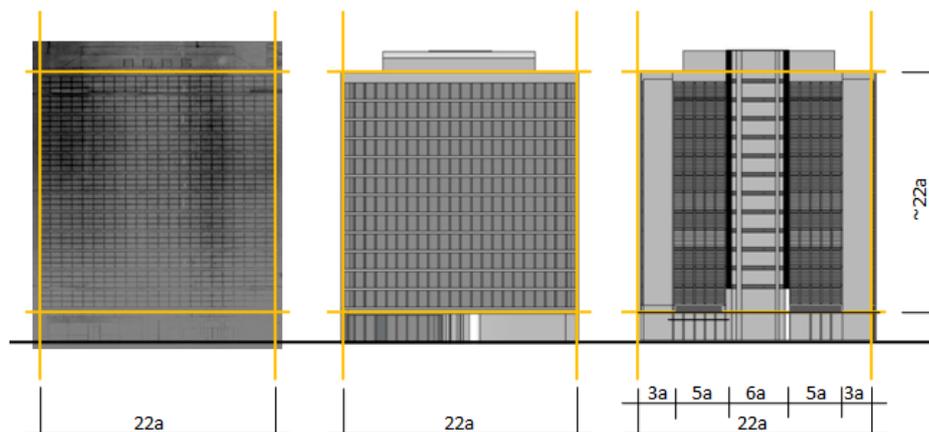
Edifício Souza Naves / INSS. Projeto original da elevação frontal e elevações frontal e posterior modeladas no *sketch up*, com intervenção gráfica da autora.
